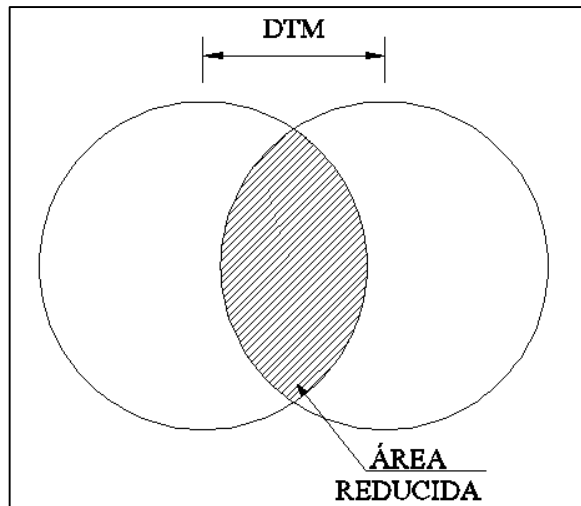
Vista en planta de la reducción del área del aislador debido a DTM
